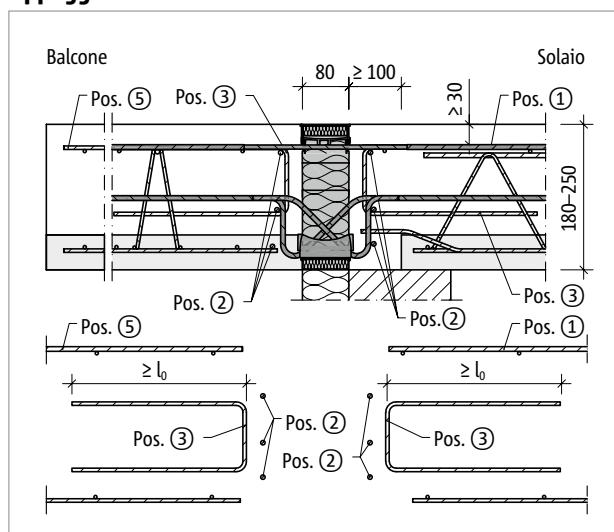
Schöck Isokorb® T tipo K-F-VV: armatura in opera con spessore soletta del balcone $h = 180-250$ mm; variante con staffa a innesto
